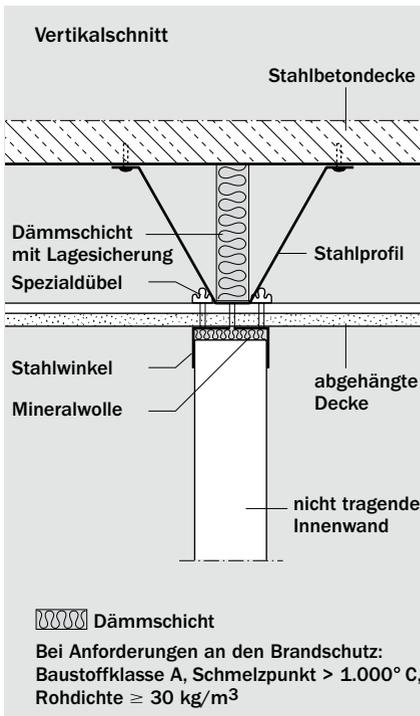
/41: Anschluss an abgehängte, schalldämmende Decke
